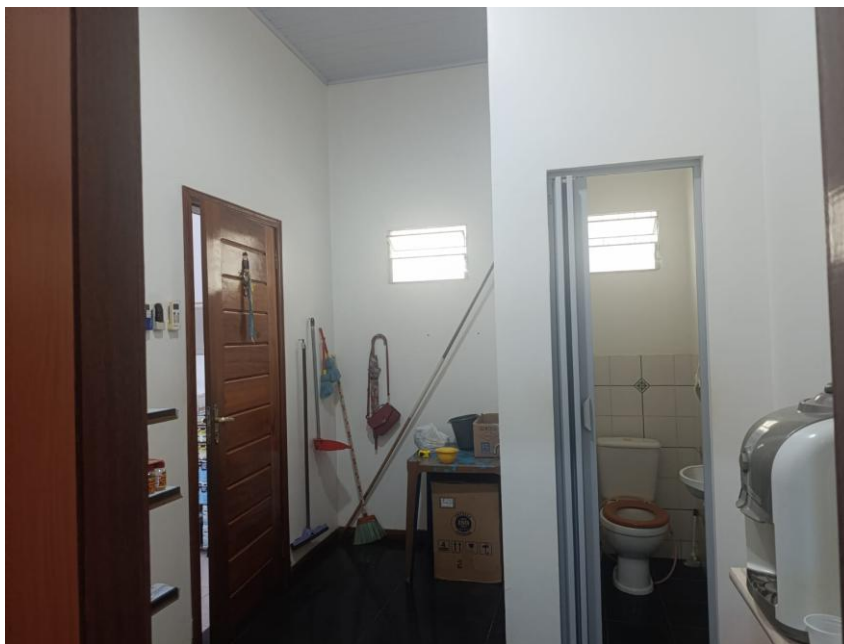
Deck Piscina/ Lavanderia/ Área Gourmet
